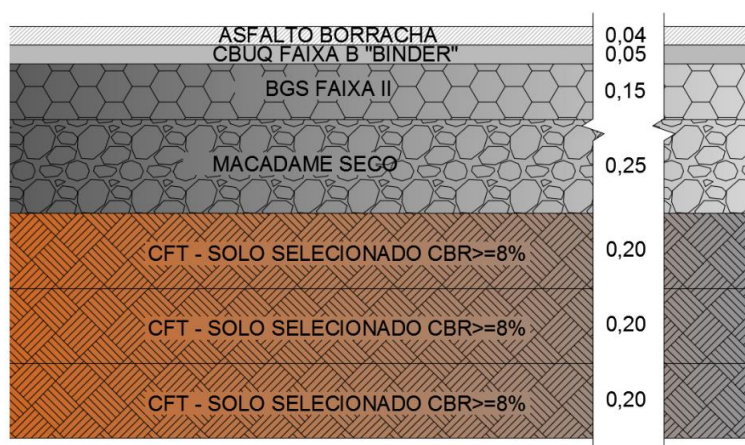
Estrutura de pavimento flexível proposta – Alternativa II
